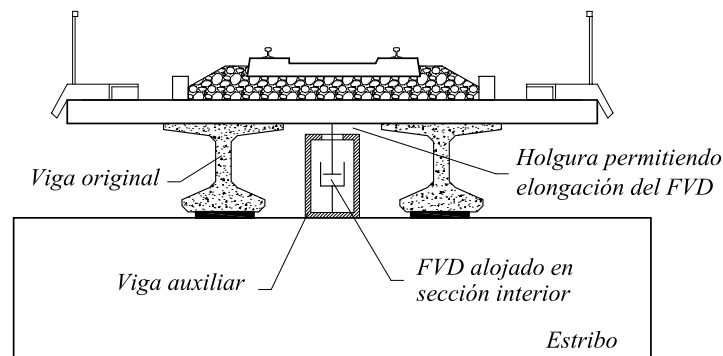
Sección de un tablero de vigas de hormigón y losa de reparto de vía única reacondicionado mediante una viga cajón metálica y un conjunto de FVD distribuidos uniformemente en su longitud
